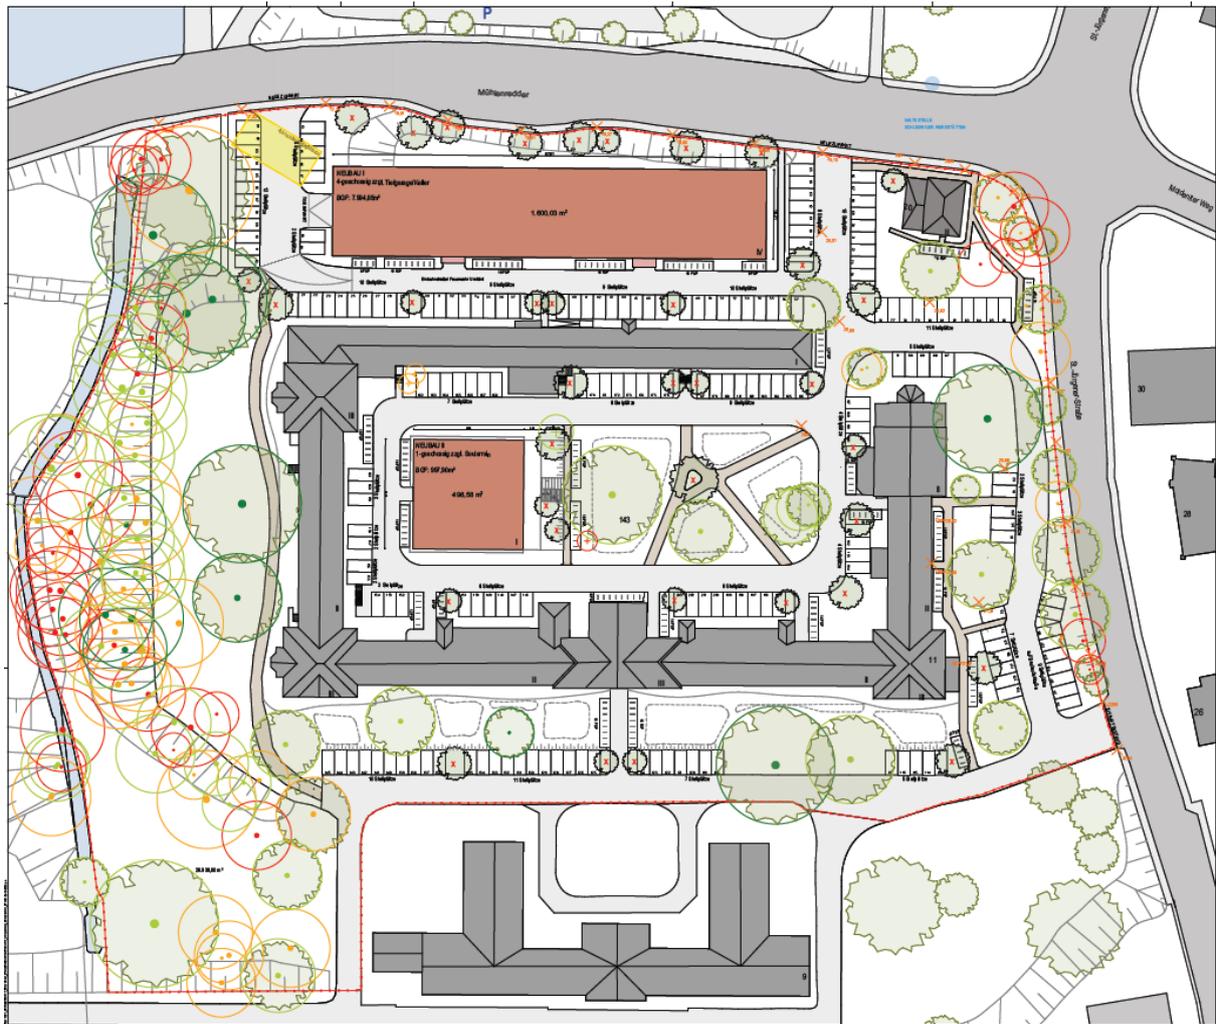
Lageplan der Fa. R-H. Architekten, Stand 23.11.2022
